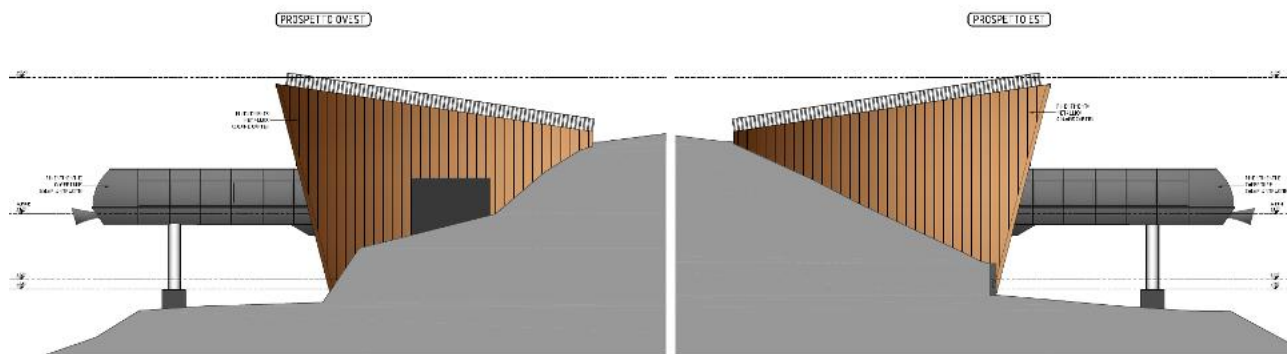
Prospetto est e ovest stazione di monte nuova telecabina - scala a vista
